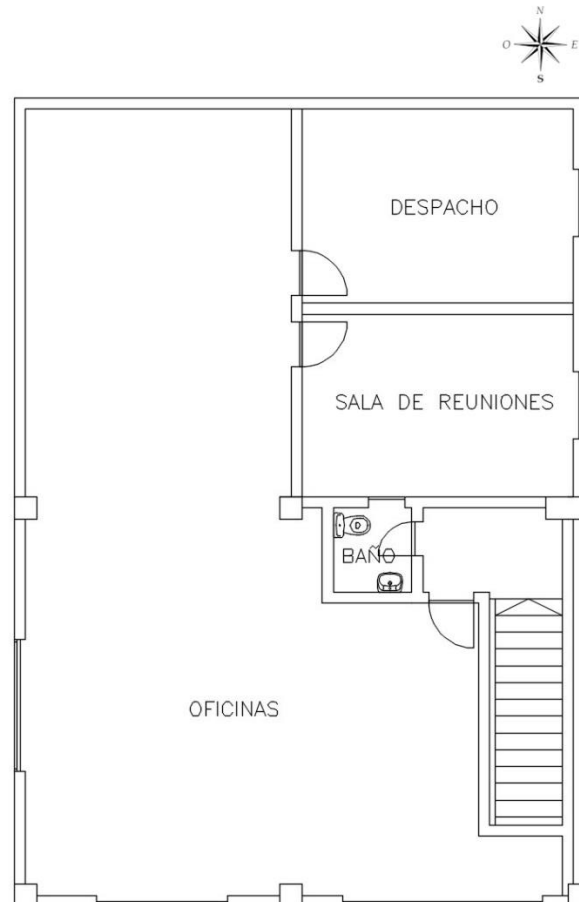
Planta del edificio de oficinas [Elaboración propia]
